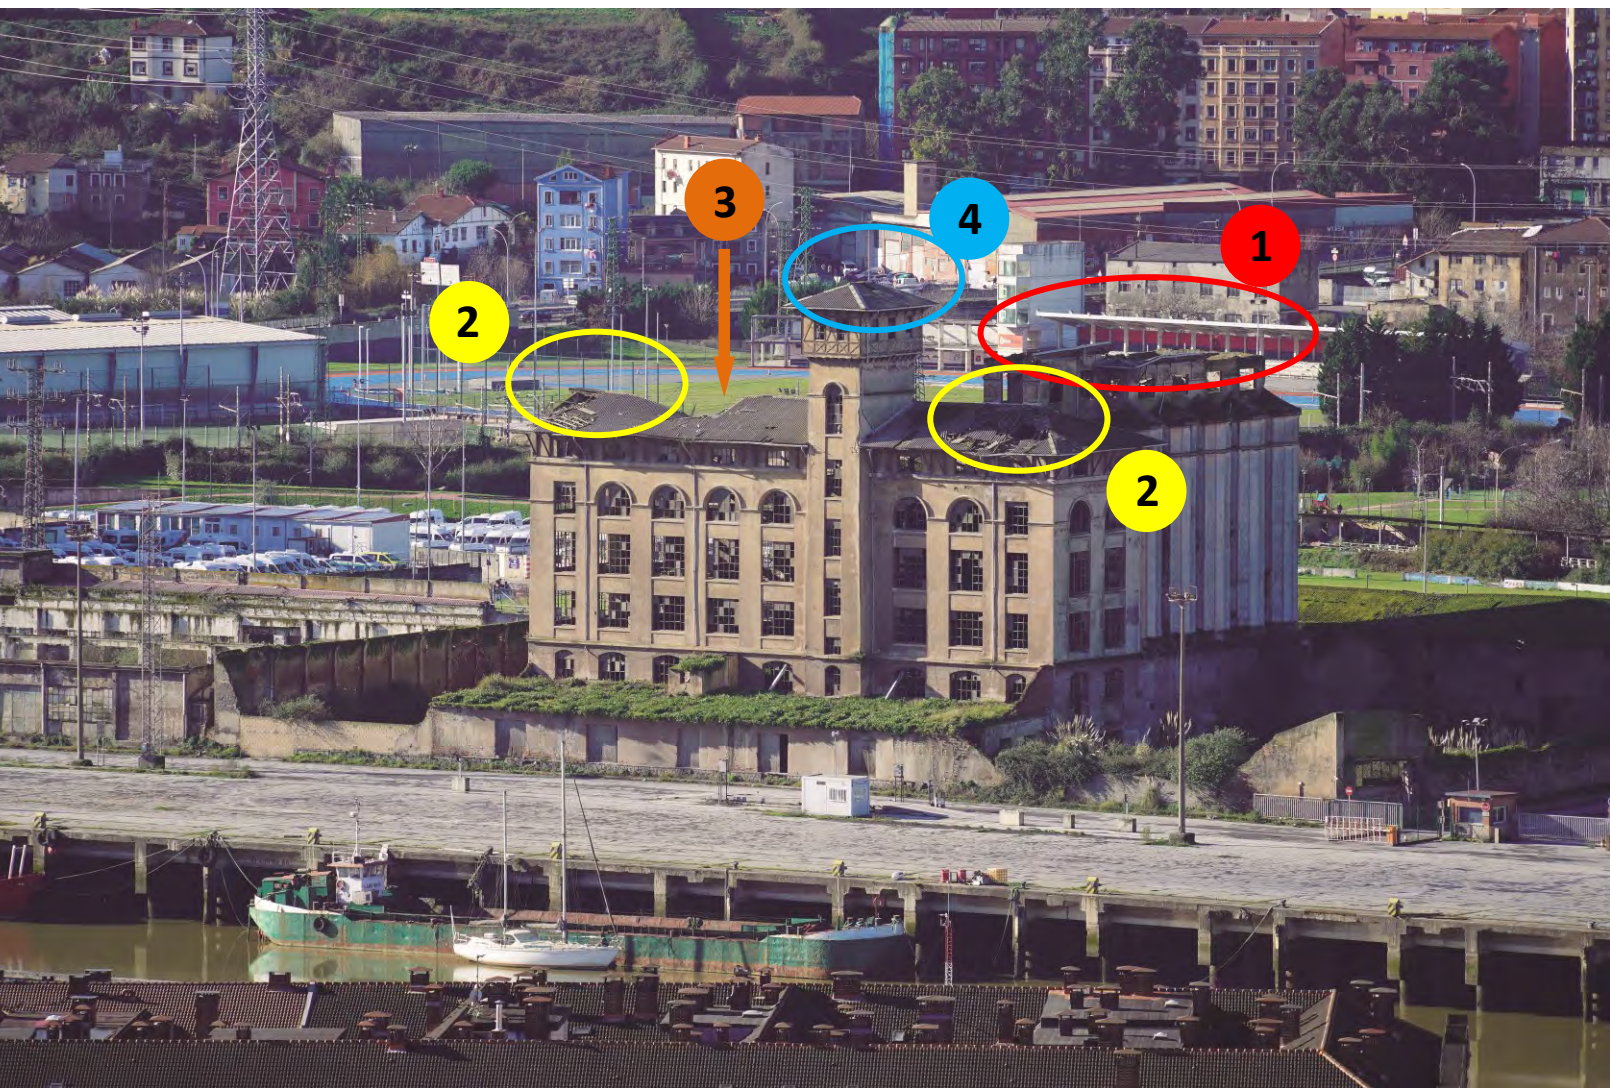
Vista elevada de la fachada frontal y lateral derecha del Edificio Principal de Grandes Molinos Vascos. En esta fotografía, además del estado general de abandono y degradación de la edificación, se puede observar el grave deterioro de las cubiertas. La cubierta a dos aguas que cubría los silos (1) ha desaparecido. La cubierta a dos aguas de la fábrica de pisos (2) tiene grandes agujeros, claramente visibles, además de haber cedido el mástil central del tejado izquierdo (3). La cubierta a cuatro aguas de la torre central (4) también muestra un visible deterioro.
